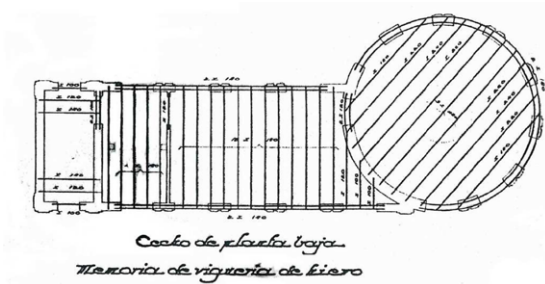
4. Planta de estructura del edificio de duchas. Imagen extraída de (Rodríguez 2008)
